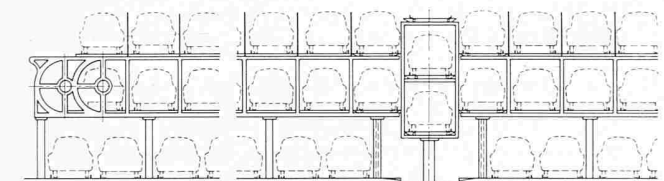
Konstruktionstyp für einstöckigen Oberflurbau
